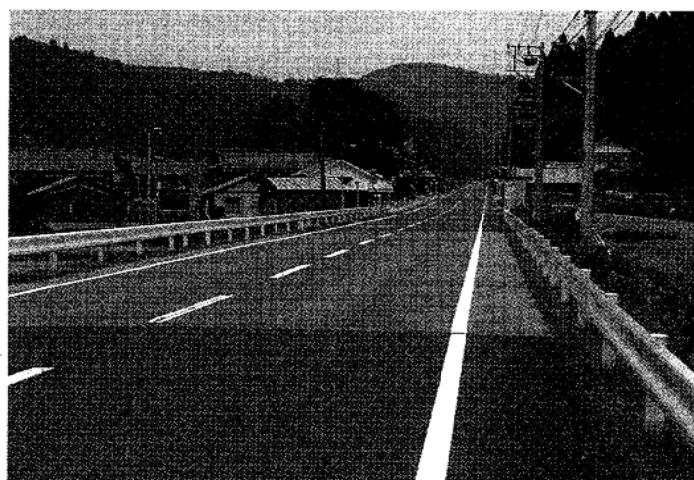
今庄の試験舗装の施工場所状況(a タイプ)
